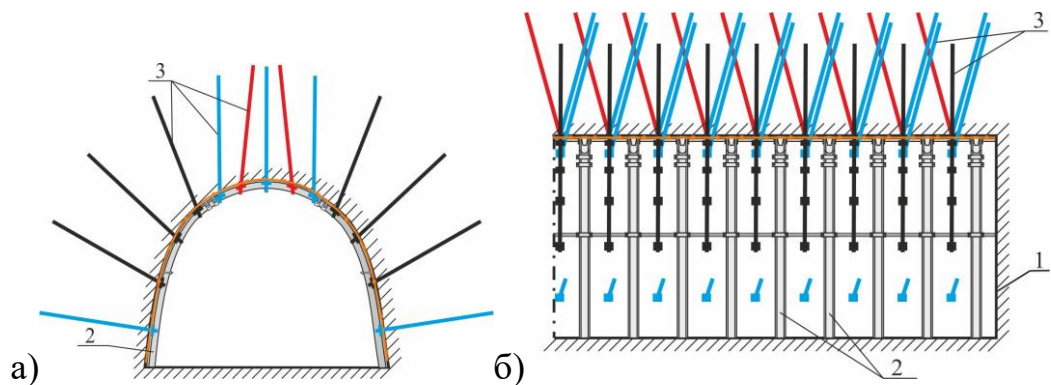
Приклад потужної схеми анкерного кріплення: 1 – вибій; 2 – рами; 3 – анкери; а) поперечний та б) повздовжній переріз
